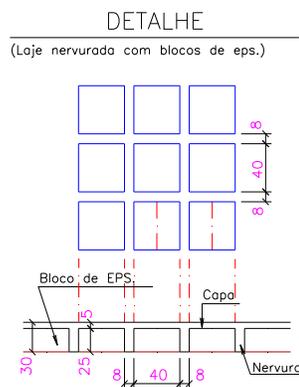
Detalhe da laje nervurada (unidades: cm)
